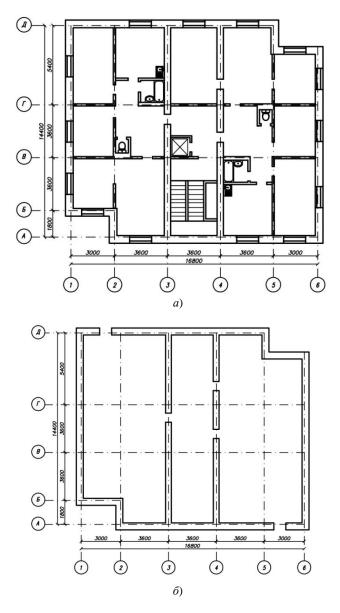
Вариант 3: a — план типового этажа; δ — план подвала
